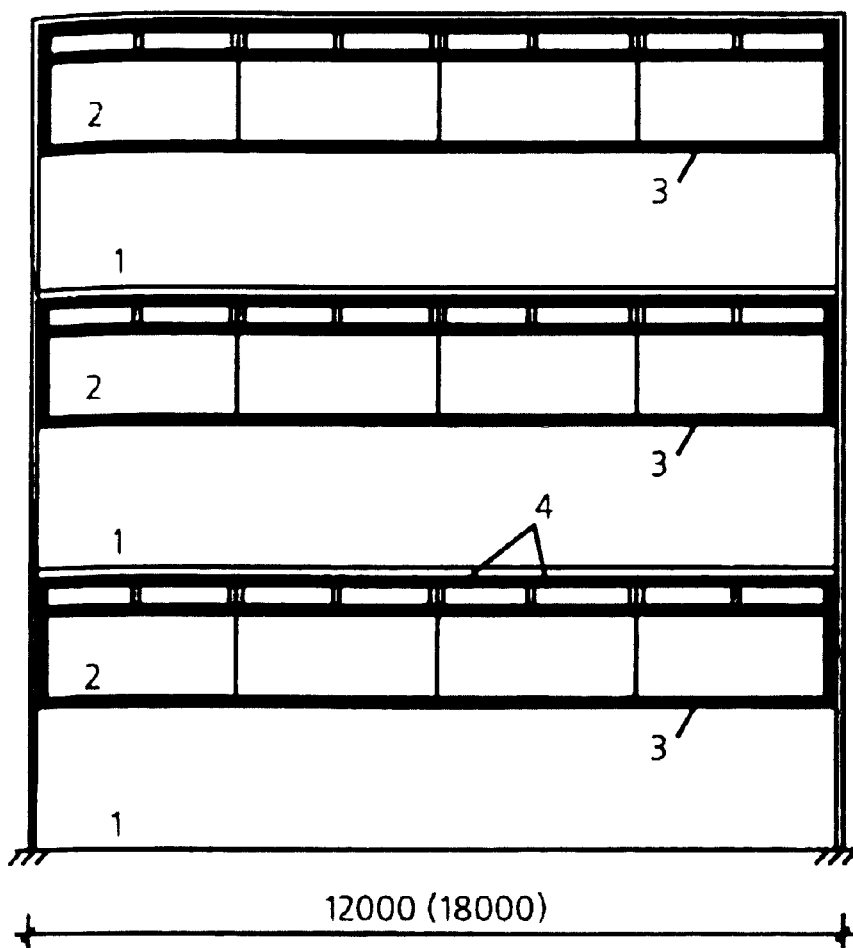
Схема поперечной рамы каркаса с межферменными этажами: 1 - производственный этаж; 2 - межферменный этаж; 3 - ферма; 4 - плиты перекрытия
